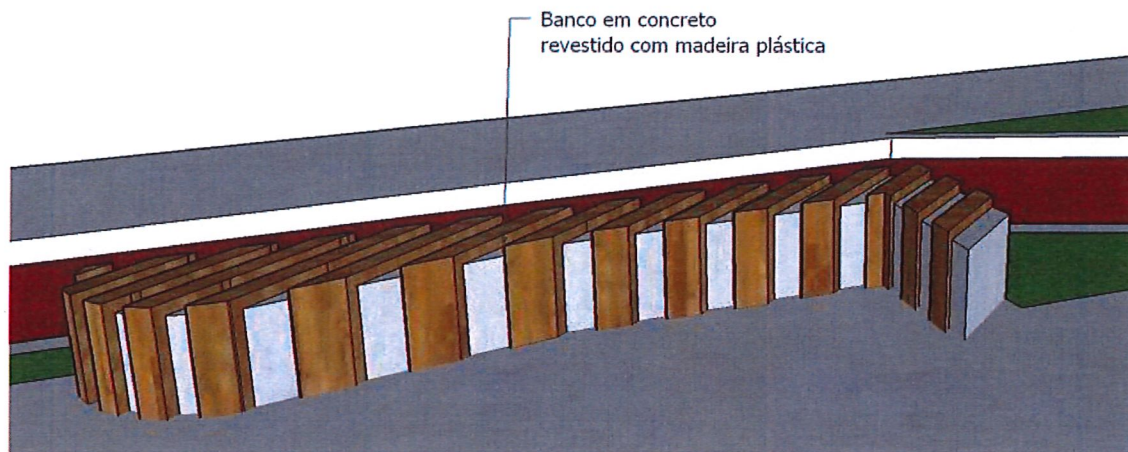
Modelo de Banco de Concreto revestido em madeira plástica
